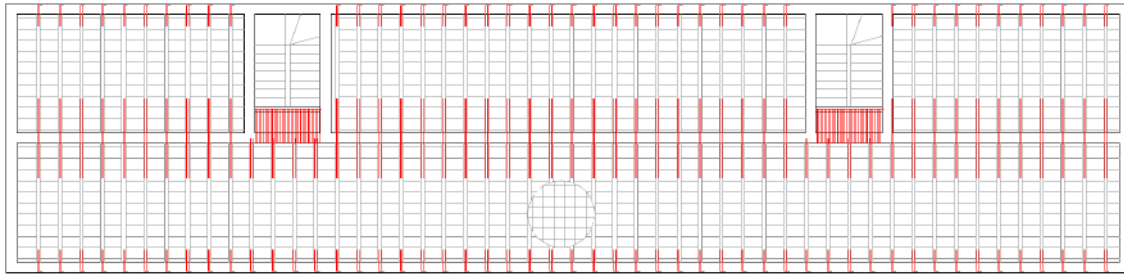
Forjado unidireccional de planta primera. 2016. Fuente Propia
